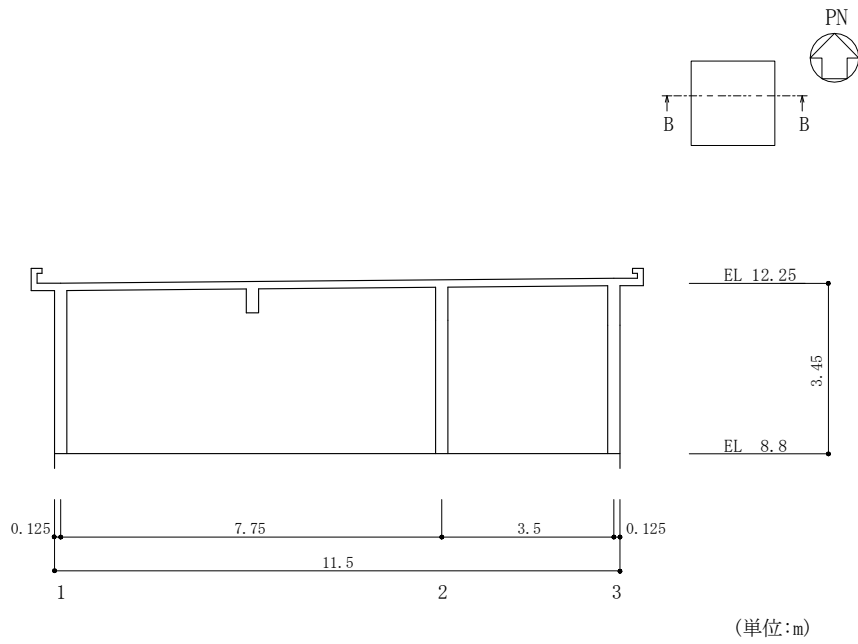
(2) 排気筒モニタ室の概略断面図 (B-B 断面, EW 方向)
